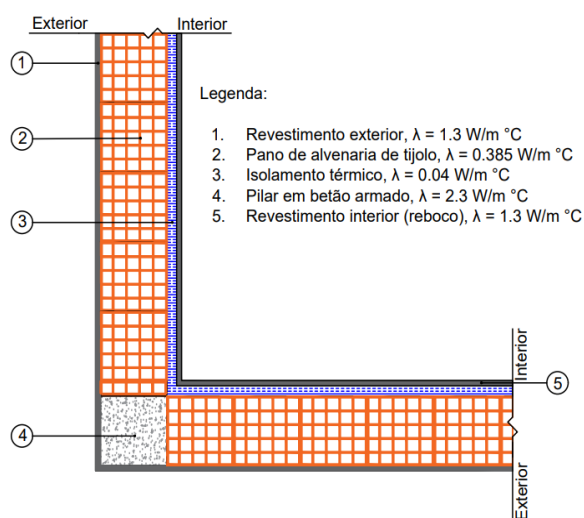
Pormenor construtivo da ligação entre duas fachadas, com isolamento térmico pelo interior e pilar na zona do cunhal.
